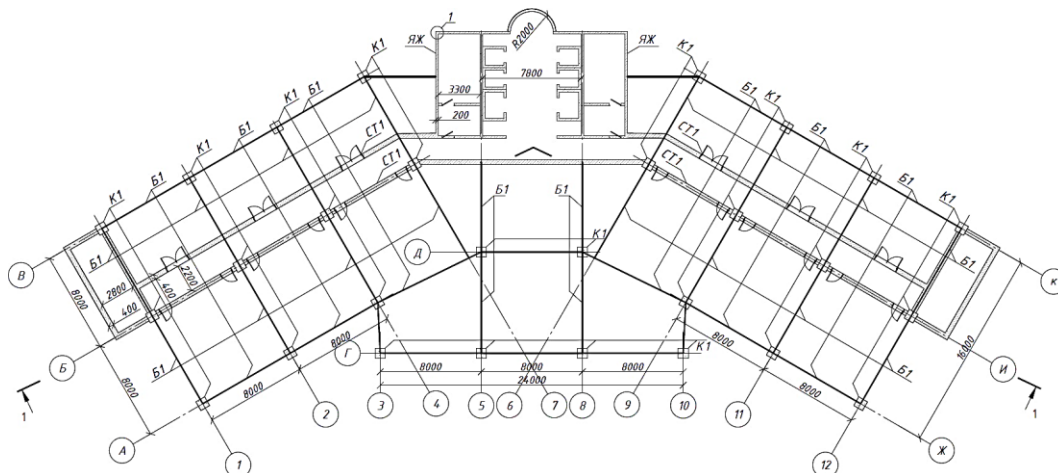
Схема розташування несучих елементів залізобетонного каркасу
